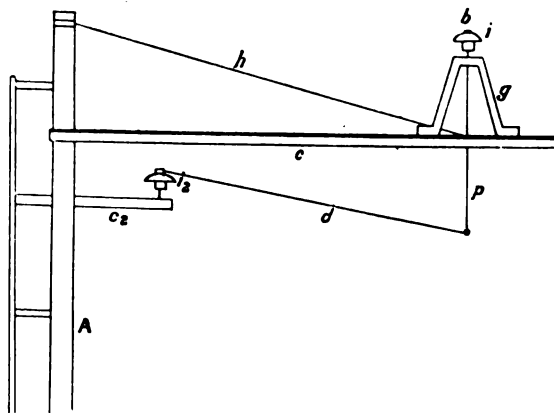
Suspension Westinghouse pour portées de 60 m.
